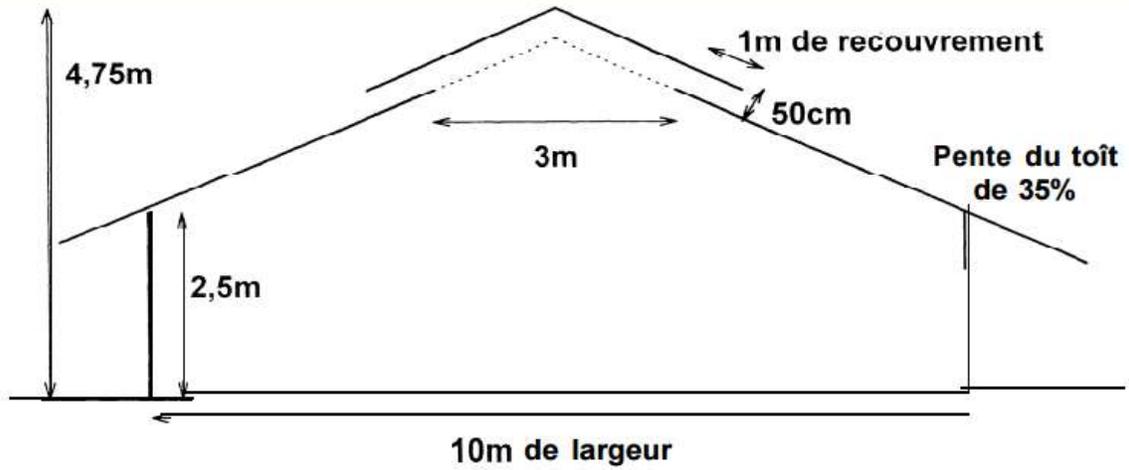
Plan du bâtiment d'élevage (KOUZOUKENDE T.N, 2000)
